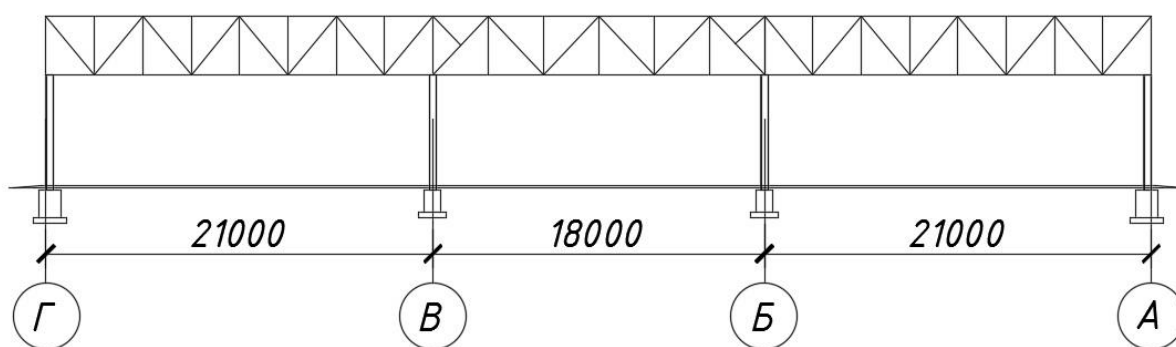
Конструкция из стальных колонн и решетчатых ферм
